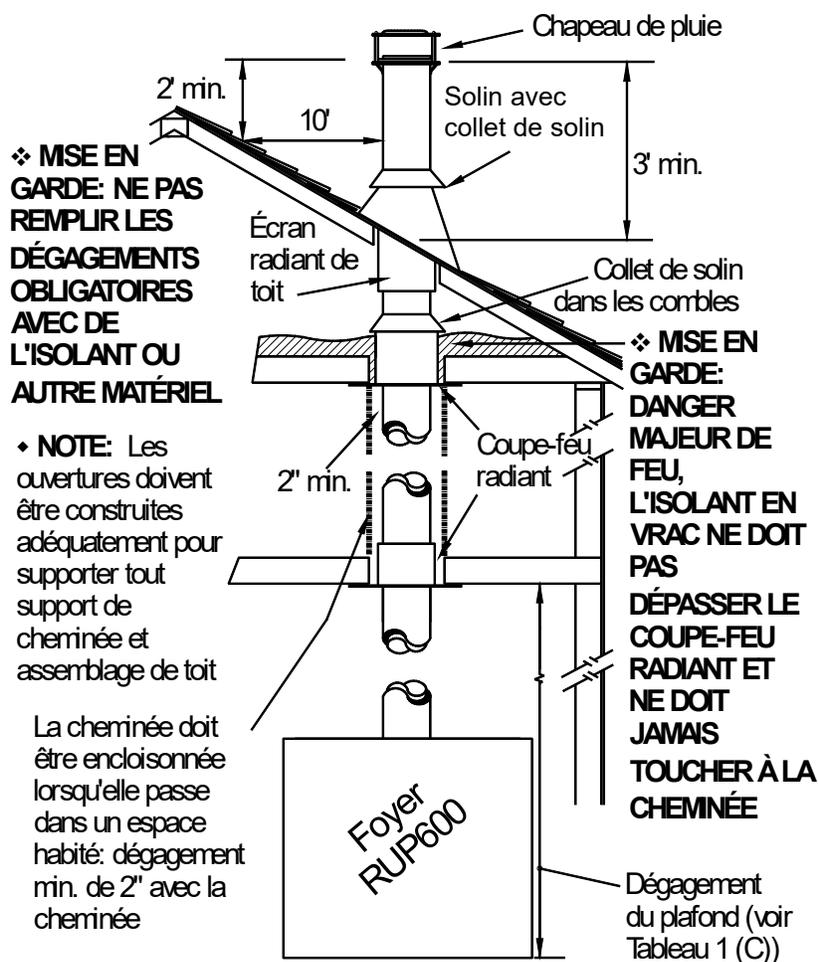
APERÇU DES CONSIGNES POUR LA CHEMINÉE
